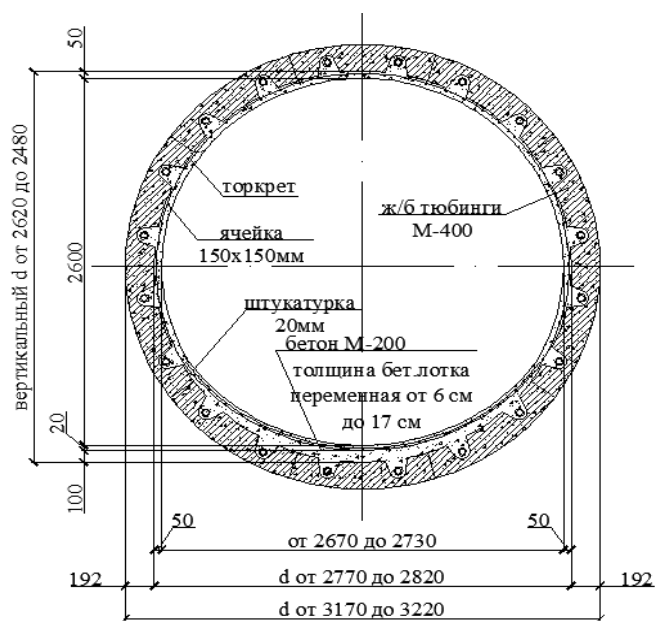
Конструктивный разрез принятой в расчет двухслойной обделки
